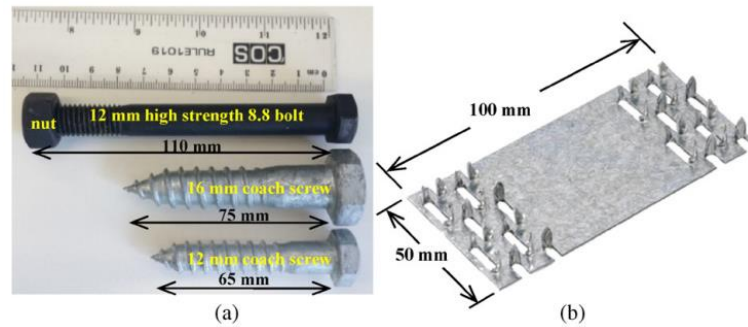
Conectores empleados en los ensayos de vigas mixtas acero-LVL [9]
